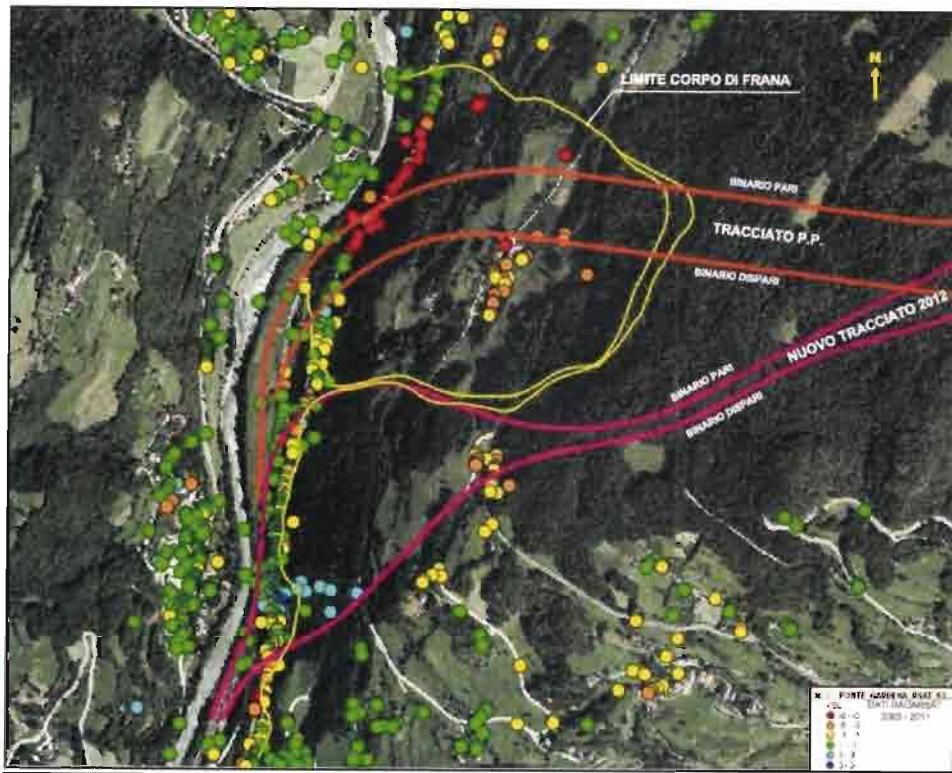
Planimetria con i dati di monitoraggio satellitare e con lo sviluppo del nuovo tracciato 2012, posto a confronto con studi per l'ottimizzazione del tracciato di Progetto Preliminare nell'ambito del sub lotto Funzionale. In giallo l'estensione dell'area di frana.
